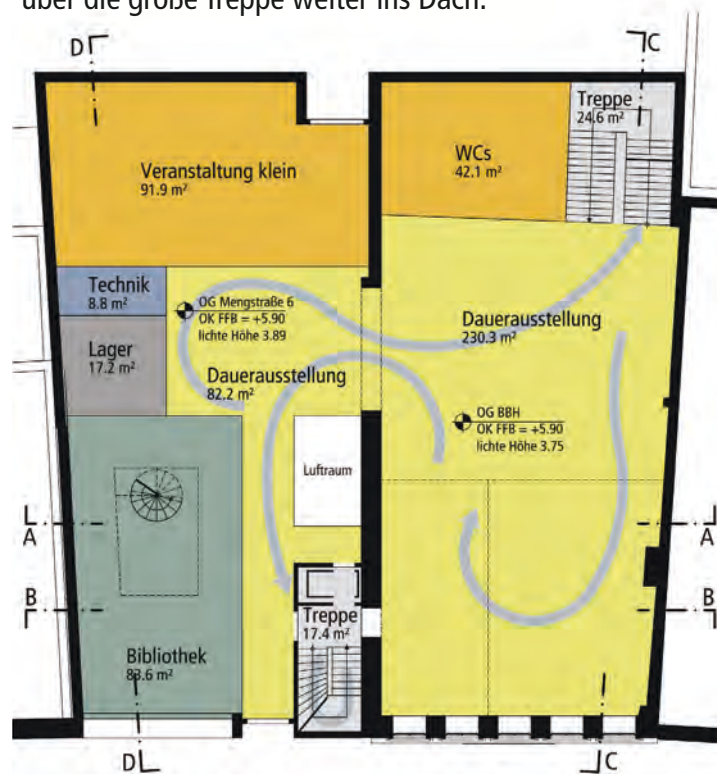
Variante 3, Grundriss 1. Obergeschoss
